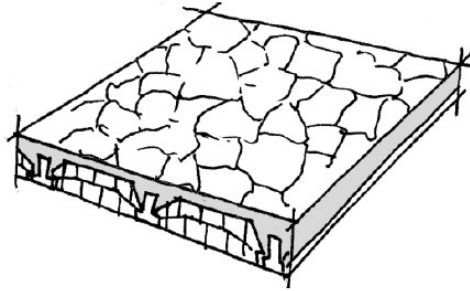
Fisuras en placa al iniciar la etapa de endurecimiento del concreto, generadas por una rápida pérdida de humedad (López, Rodríguez, Santa Cruz, et al, 2004).
